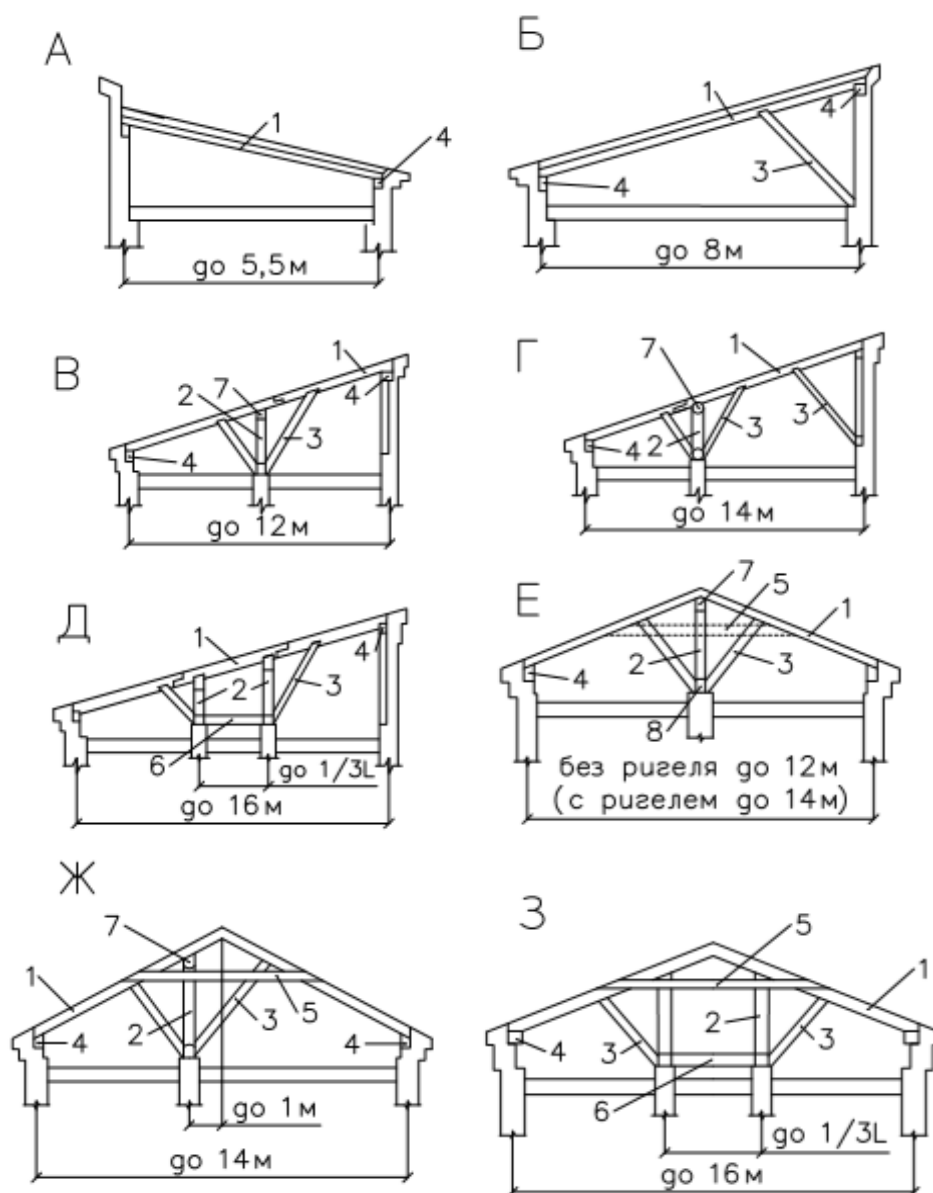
Конструктивные схемы деревянных наслонных стропил:
